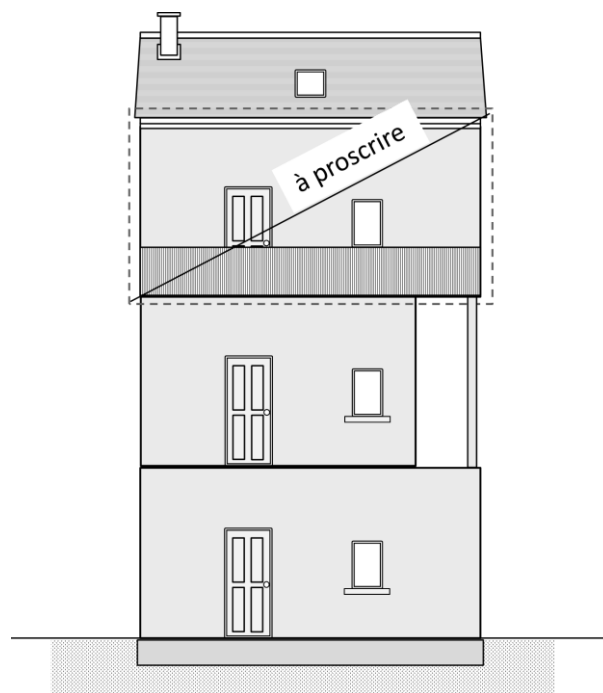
exemple de l'avancée de plancher supérieur soutenu par un poteau (à proscrire)
